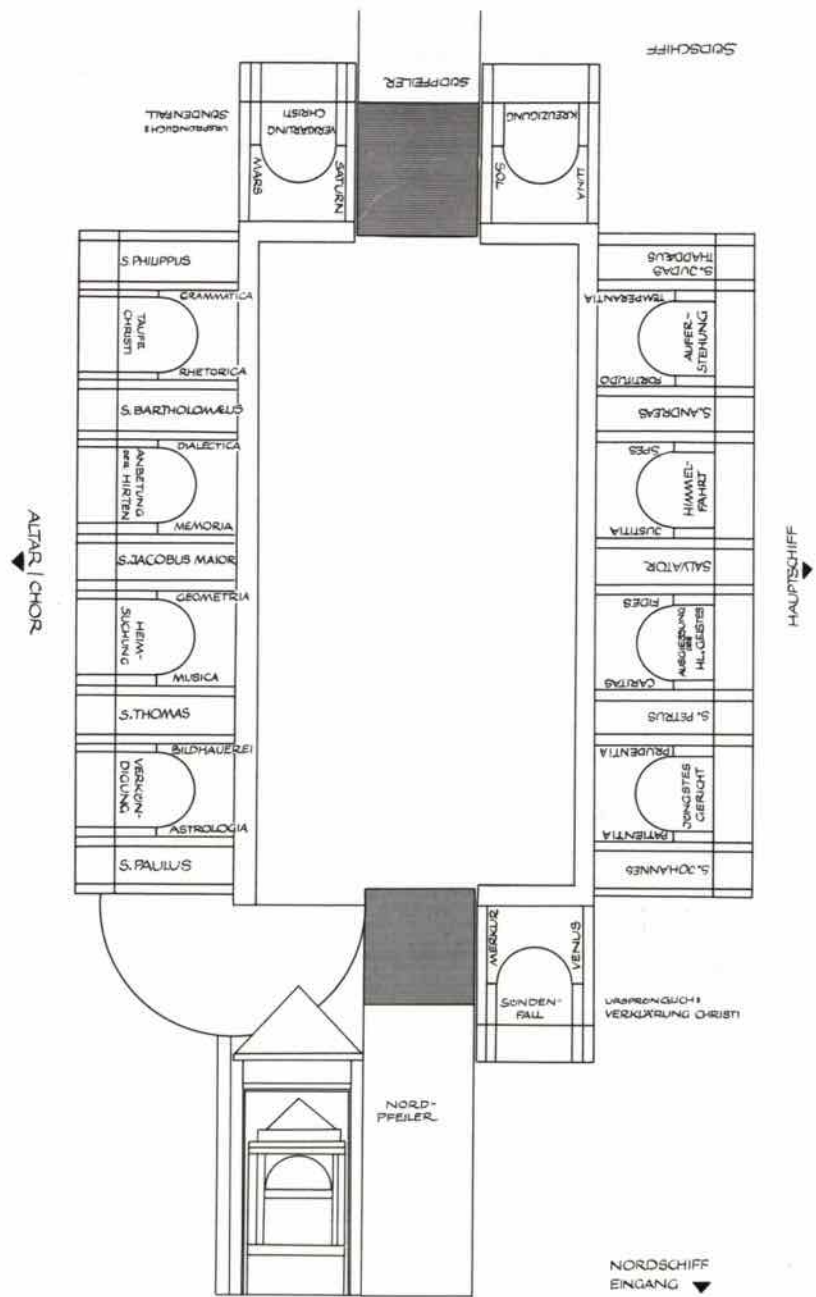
St. Ägidien, Sängerkanzel, Grundriß mit hochgeklappten Seiten.
